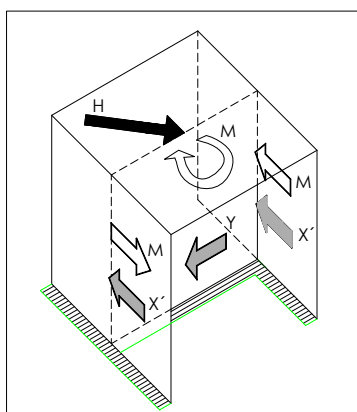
Tres planos verticales mínimos más un plano horizontal que los vincula.
